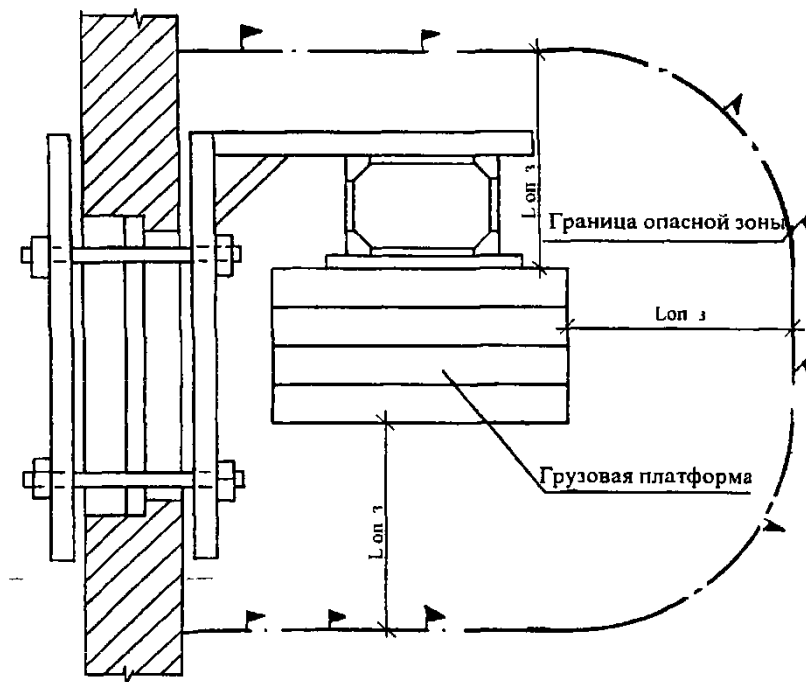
Опасная зона при работе грузового строительного подъемника
